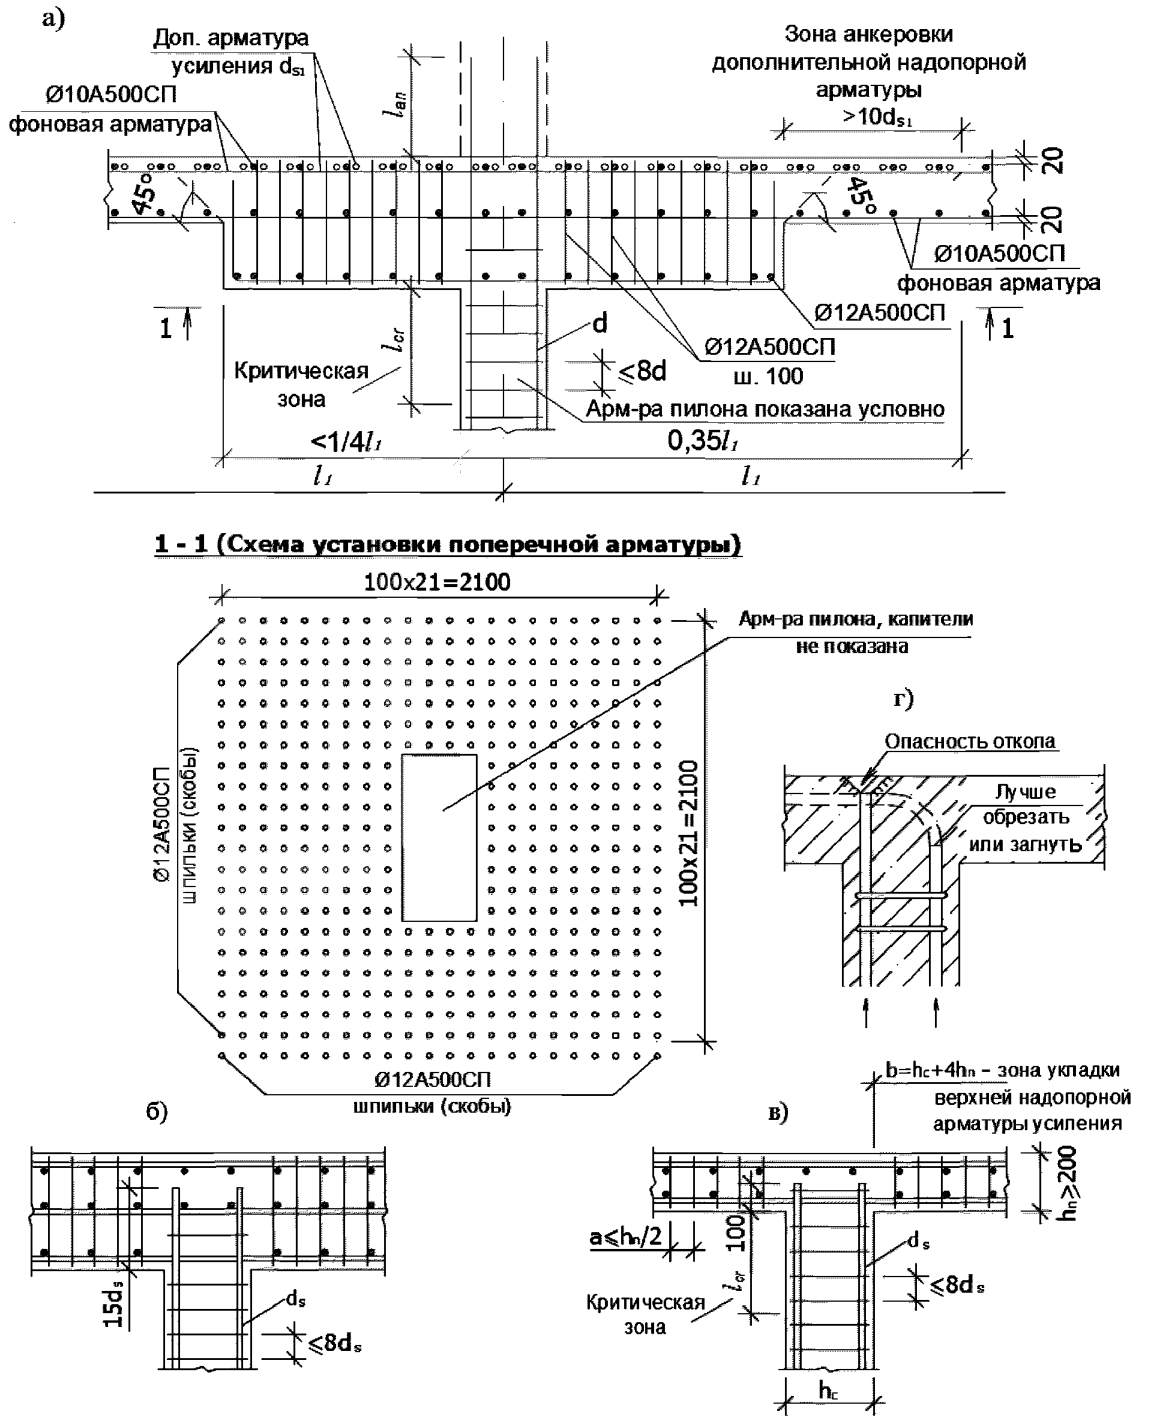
Варианты конструирования армирования участков опирания плит перекрытий (покрытий) на колонны (пилы): а, б – с капителями; в – без капителей; г – окончание сжатых стержней близ свободной поверхности бетона; l_{cr} – длина критического участка колонны (пилы) по формуле (5.1)
